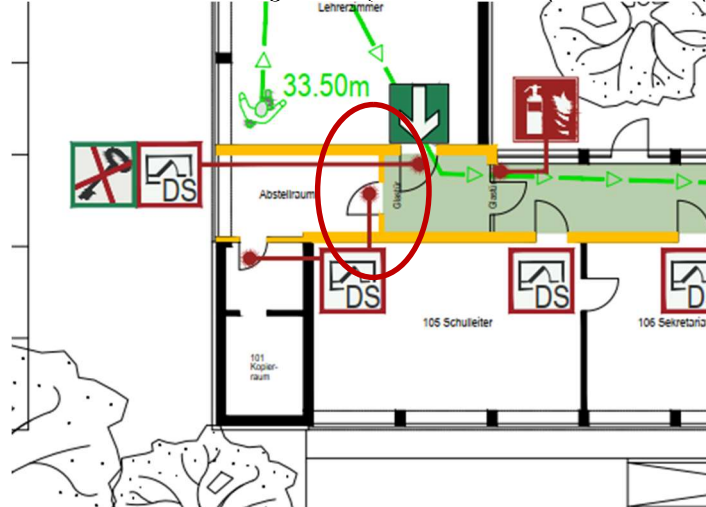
Planausschnitt Untergeschoss (Brandschutzkonzept vom 02.11.22)
